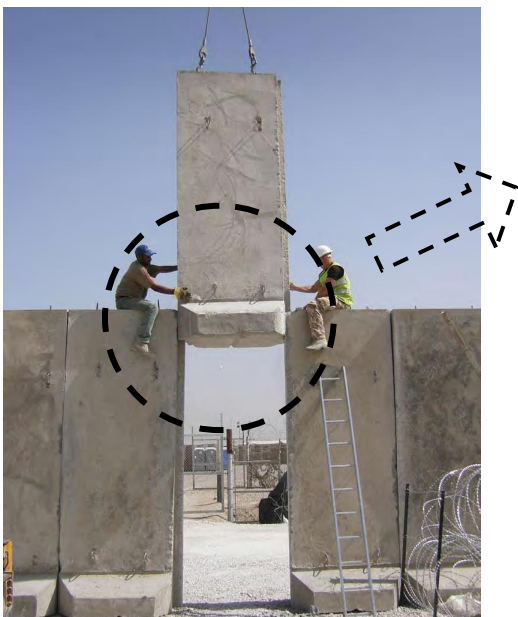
Último elemento instalado en un muro en base a T-Wall y detalle de las uniones macho – hembra que estas piezas poseen. Fuente: Force protection in Basra, Royal Engineers
